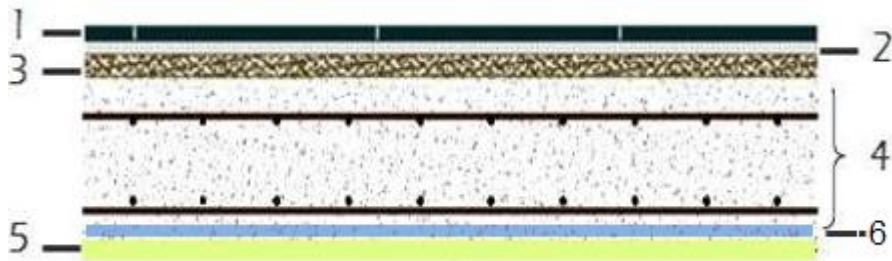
Coupe d'un plancher d'étage courant en dalle pleine.
